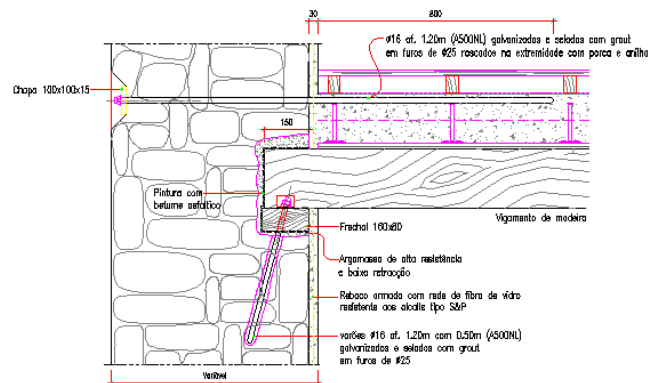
Ligação dos pavimentos mistos às paredes de Alvenarias exteriores
